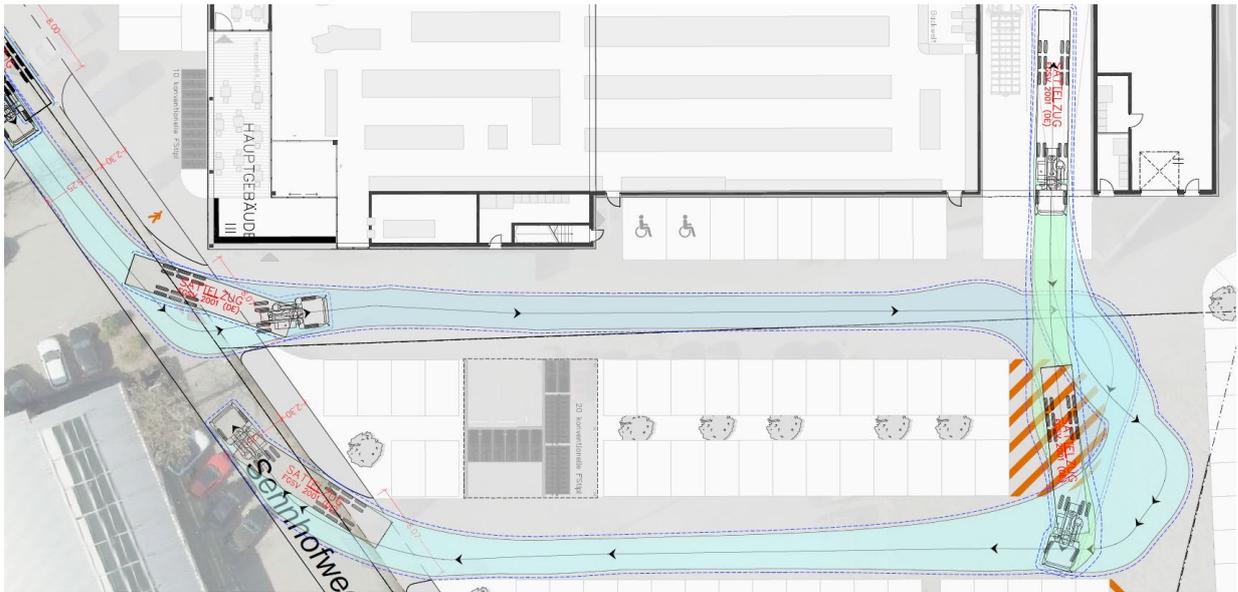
Prüfung SKP Sattelzug, Parkierungsanlage, (Architekturplan/BuP)
